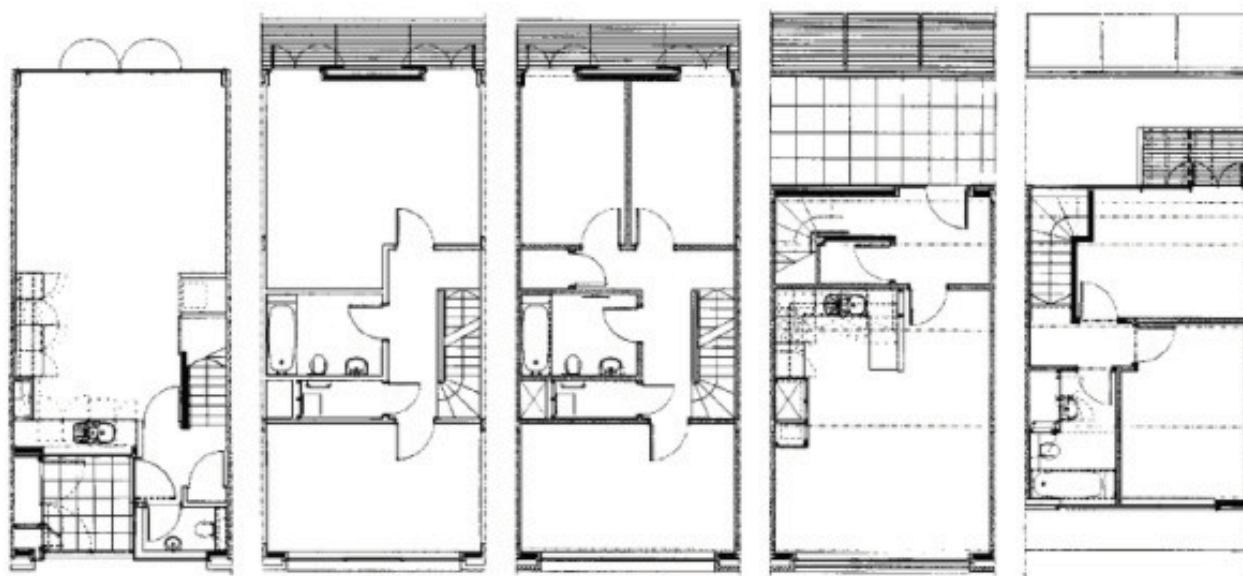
а. Жилой комплекс социального класса, Лондон. План квартиры. (Graham Towers An Introduction to Urban Housing Design. At Home The City: Great Britain: 2005)
